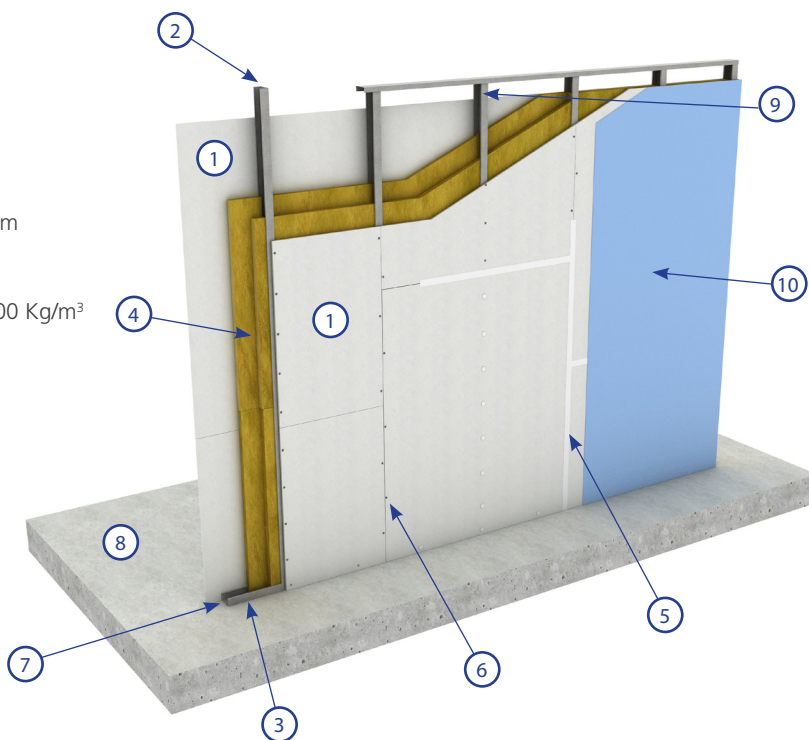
Tabiquería PassiveTec® - Montante galvanizado
